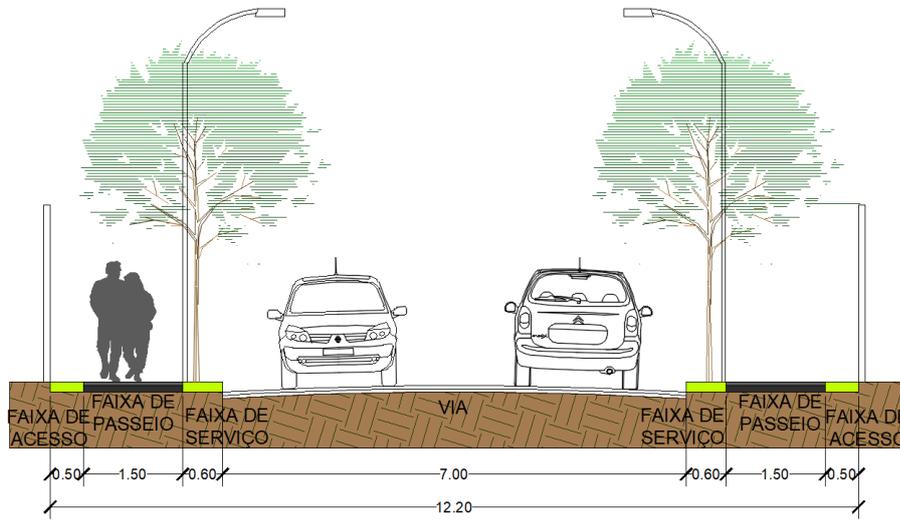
Perfil da Via de Circulação de Vizinhança 2 – Perfil 04 (Fonte: Própria)
